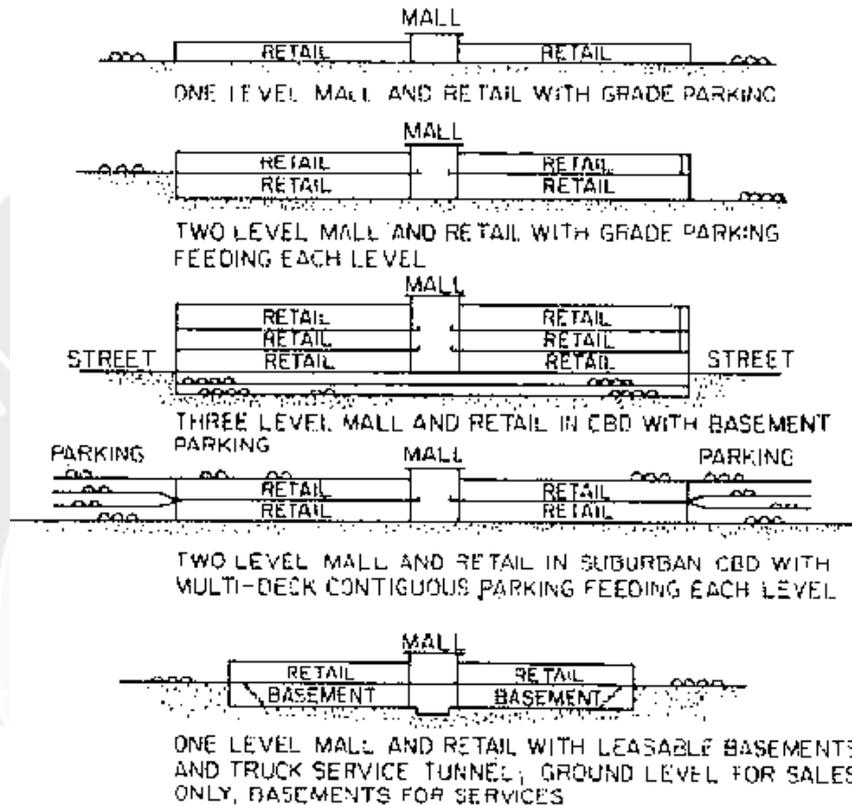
7 Susunan Layout Denah Pusat Perbelanjaan
